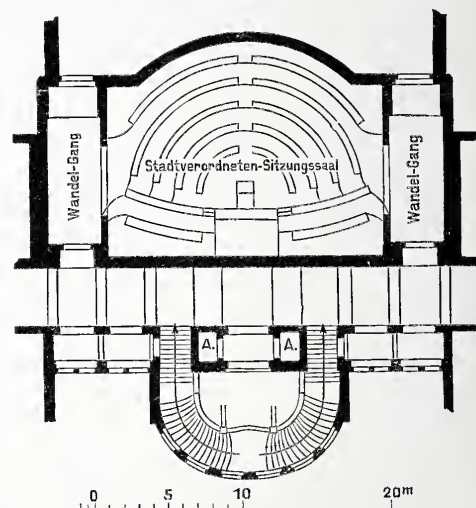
Grundriss vom Treppenhaus und Stadtverordneten-Sitzungssaal.
